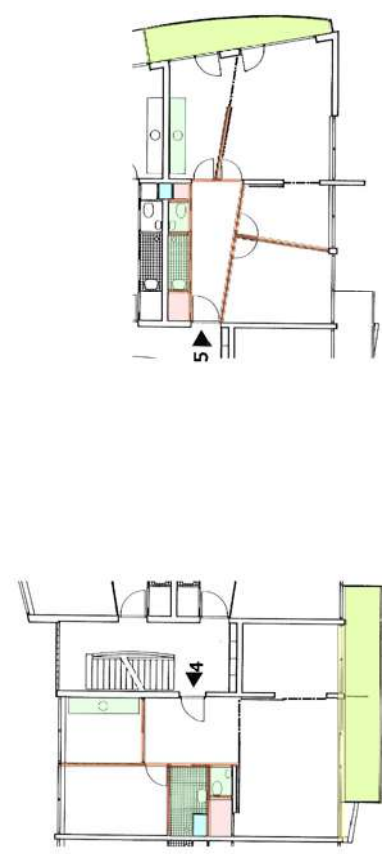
Fragmento da Planta 2° e 3° Pav. E: 1/200
